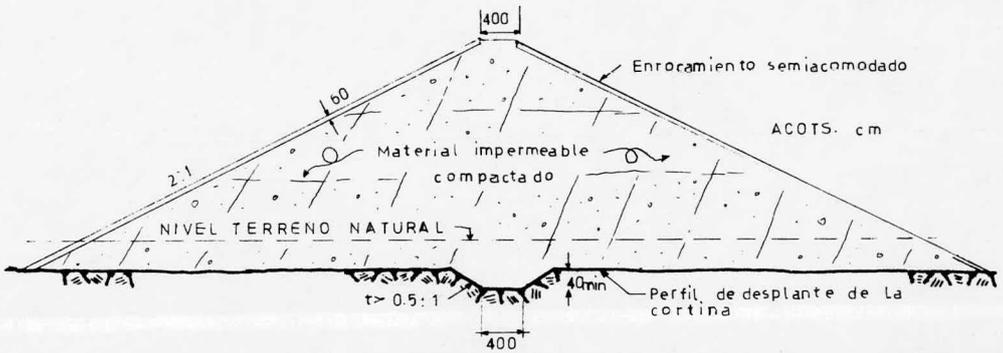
Trinchera en cimentación de roca, fracturada.
